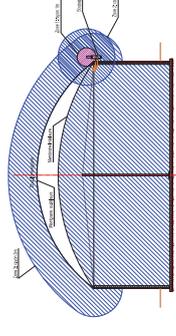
Plan de coupe des zones ATEX au niveau du digesteur et post-digesteur
